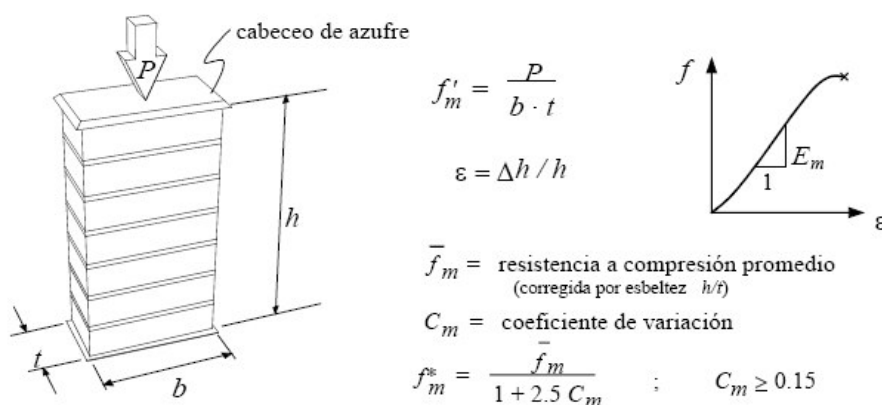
Ensayo de Pilas o Prismas de Mampostería a Compresión Axial.
